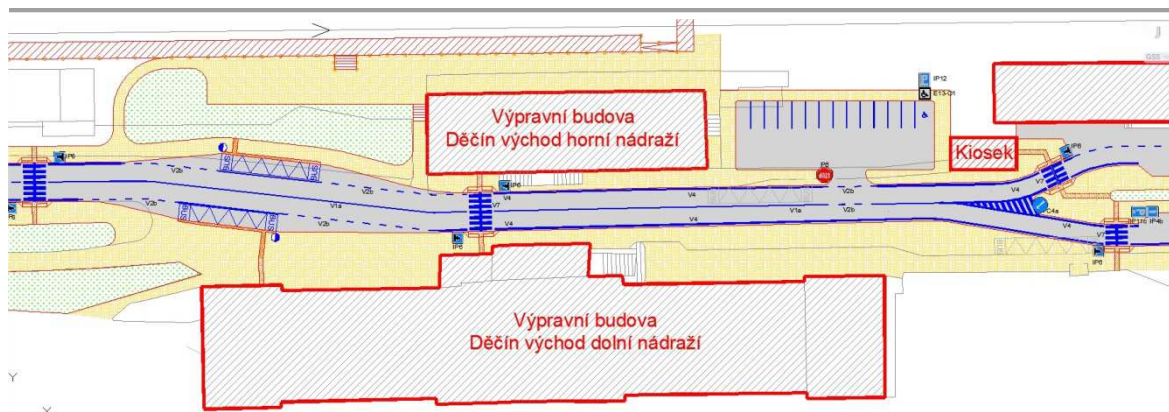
Úprava prostoru přednádraží varianta 1. (nově navržený stav)
